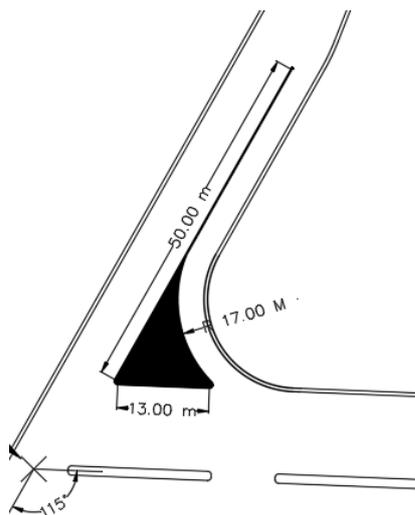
Dimensión de Isleta vía Machala - Guayaquil
